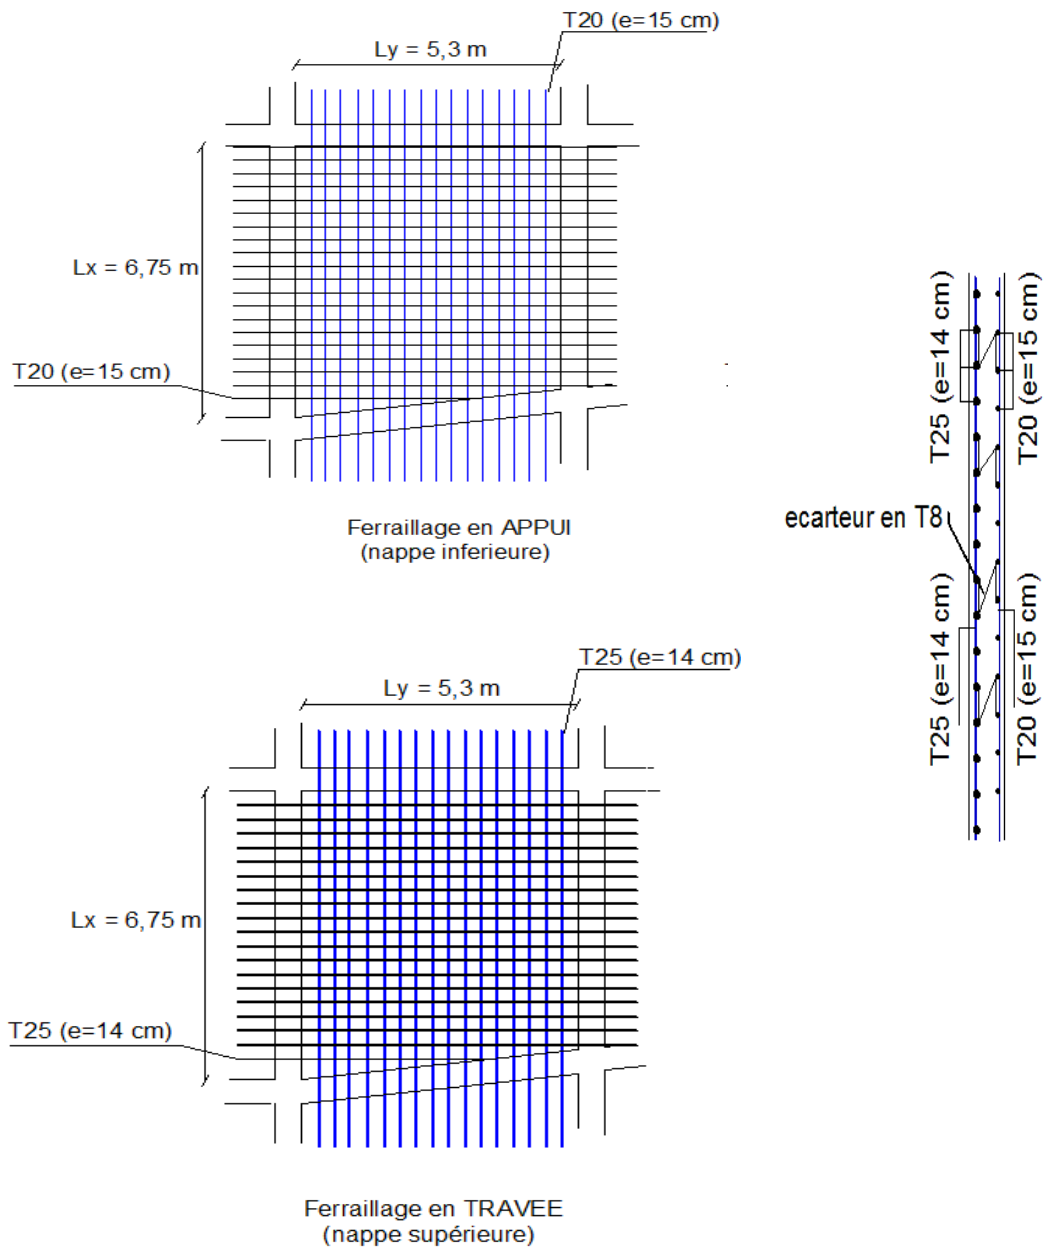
Schéma de ferraillage de la dalle de radier
